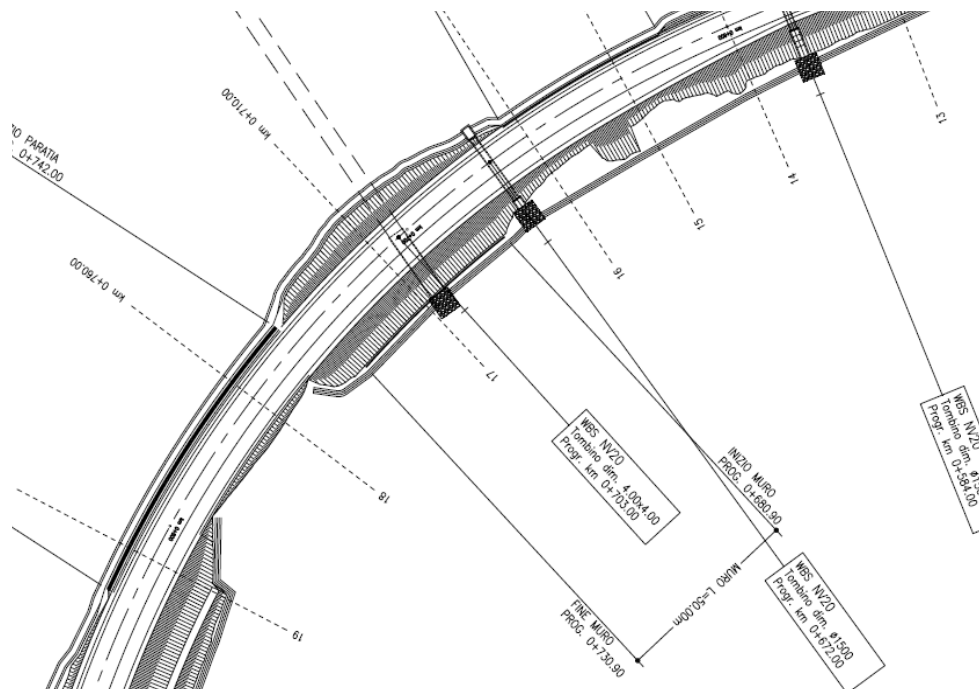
Planimetria di progetto (posizione definitiva)
